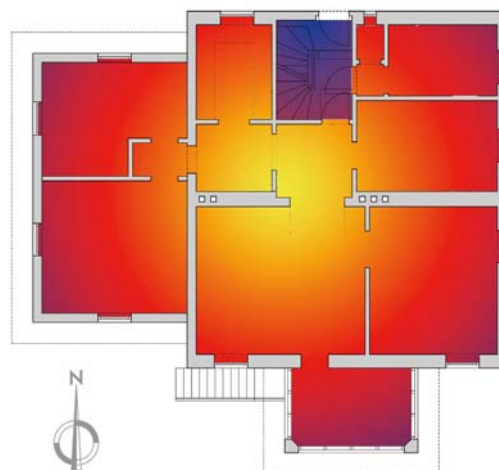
Grundriss EFH beheizte und unbeheizte Zonen
